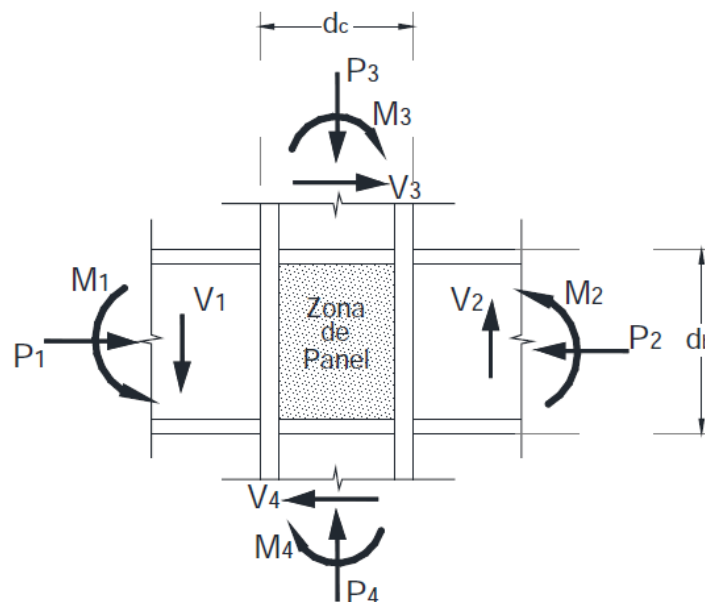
Fuerzas internas Actuando en la Zona de Panel de un PEM sujeto a carga lateral, FUENTE: NEC-SE-AC
